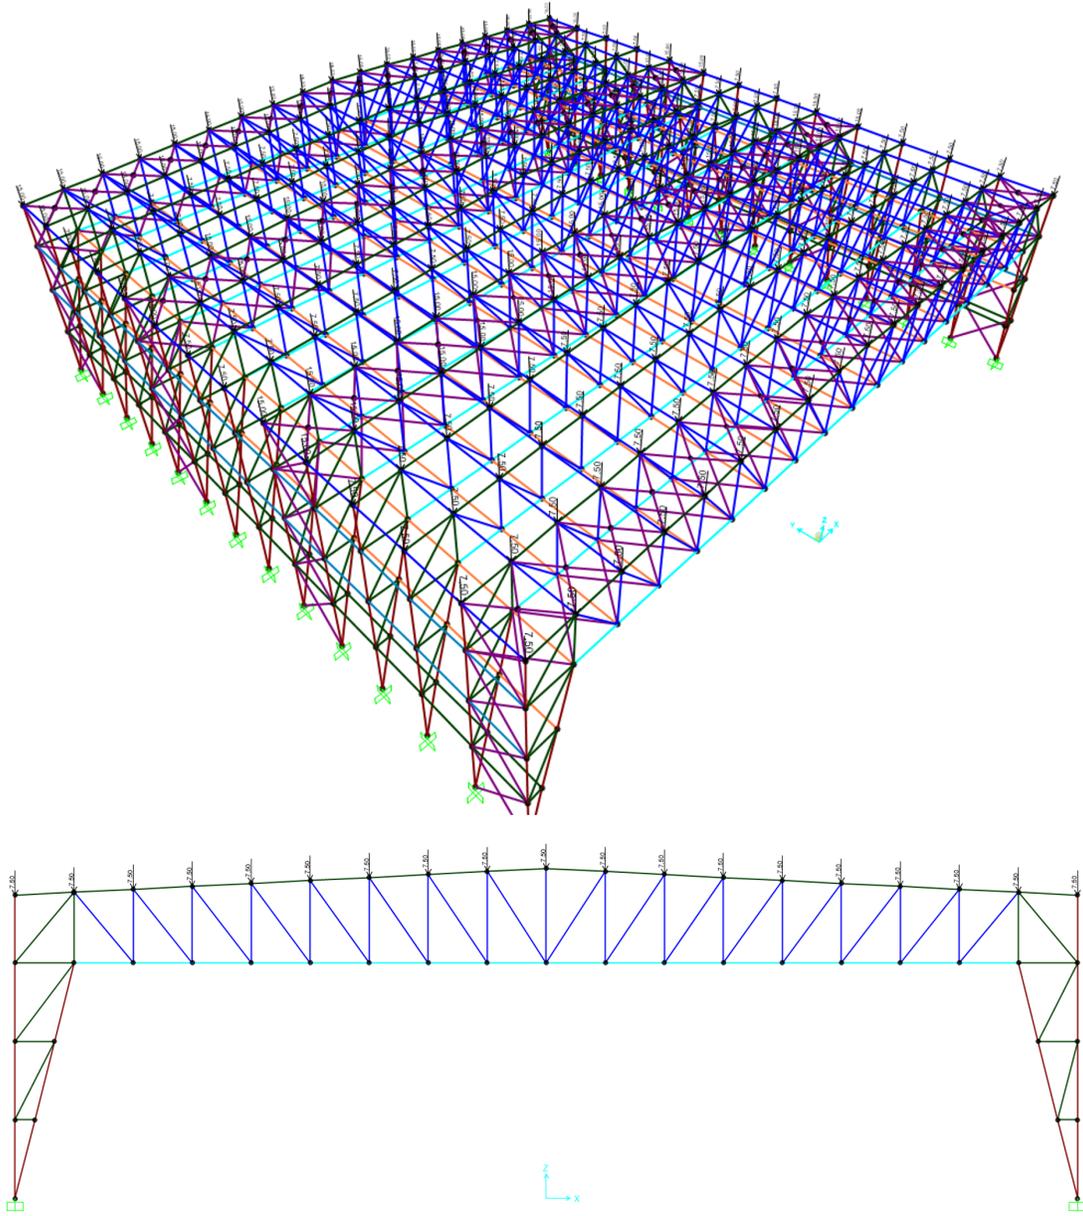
Carga de sobrecarga de uso sobre la estructura 3D y el pórtico tipo. Elaboración propia.
